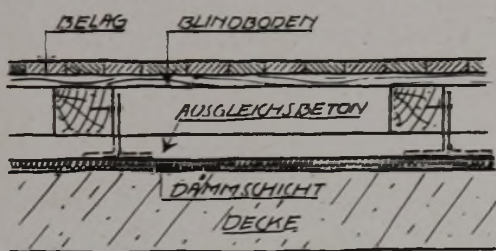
Die gleiche Massivdecke in schalltechnisch einwandfreier und wärmetechnisch verbesserter Ausführung mit durchgehender Dämmschicht. Die Betonausführung in größerer Stärke macht die Decke schwingungsträge.
